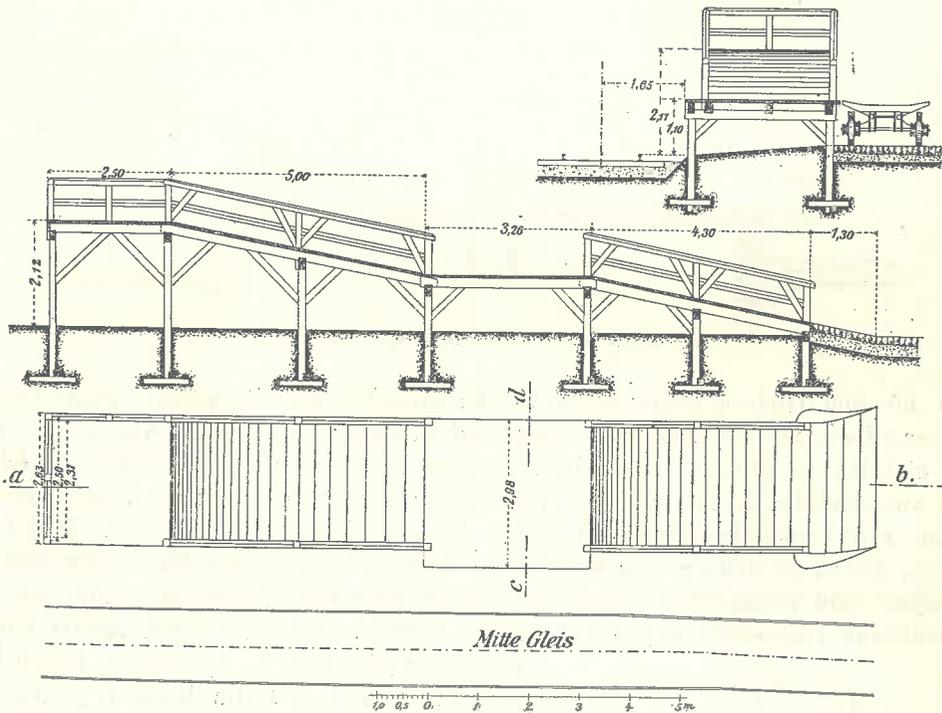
Zweigeschossige Rampe für geringen Verkehr.
